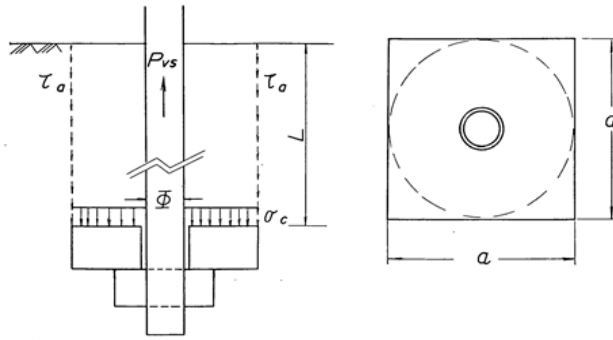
アンカーボルトの引抜き力によるコンクリート応力
